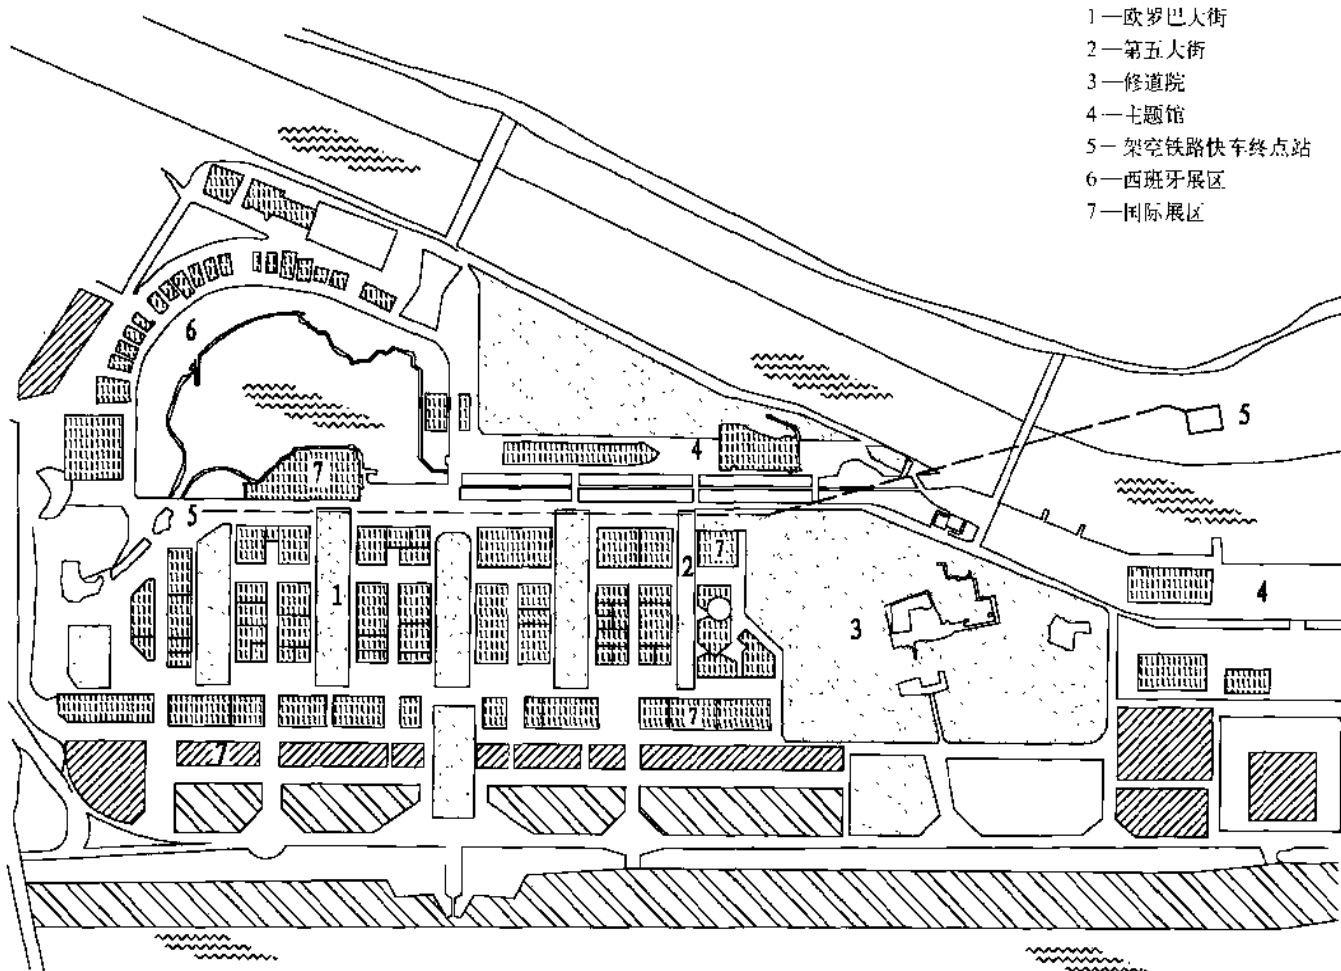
1992 年西班牙塞维利亚世博会会场总平面图
